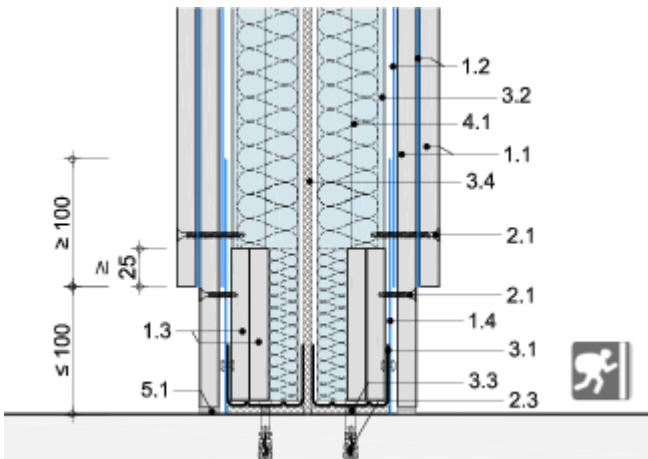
Fußpunkt mit Sockelhinterlegung Einfachständerwand RC 3
